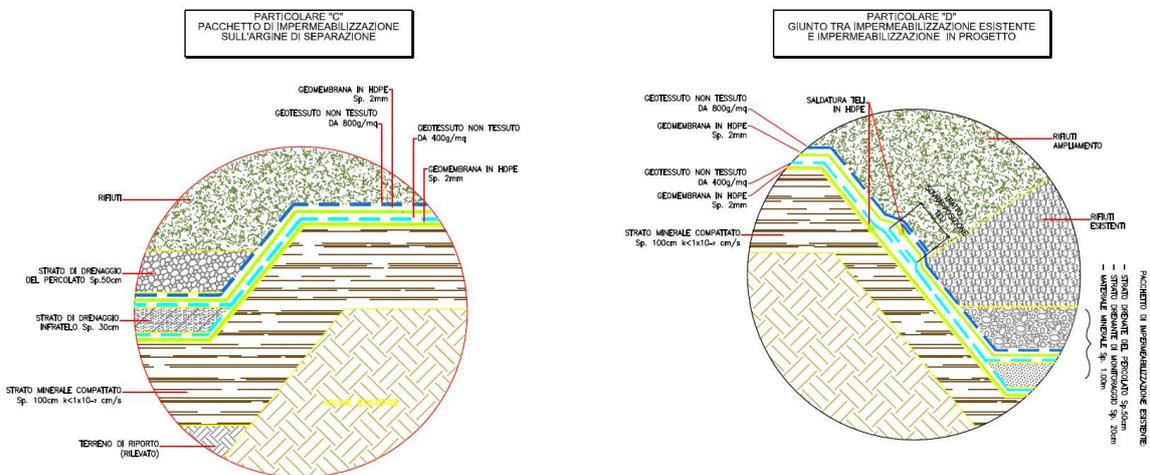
Particolare C e D dettagli pacchetto di impermeabilizzazione
